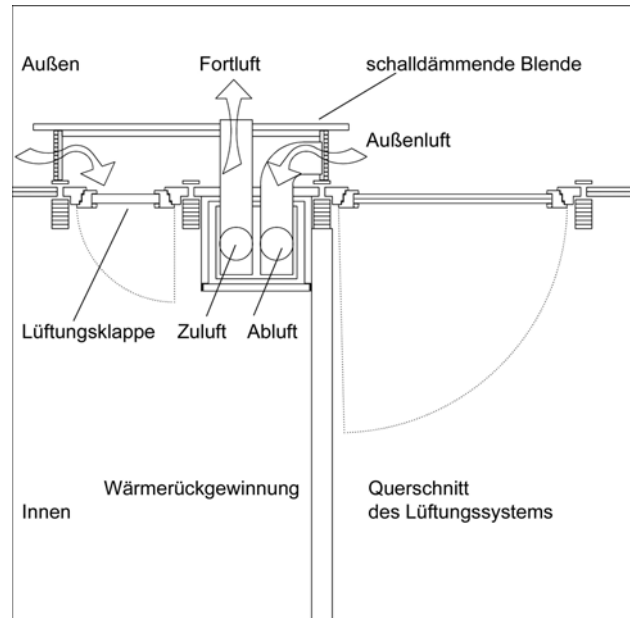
Horizontalschnitt Fassade mit Lüftungs-
